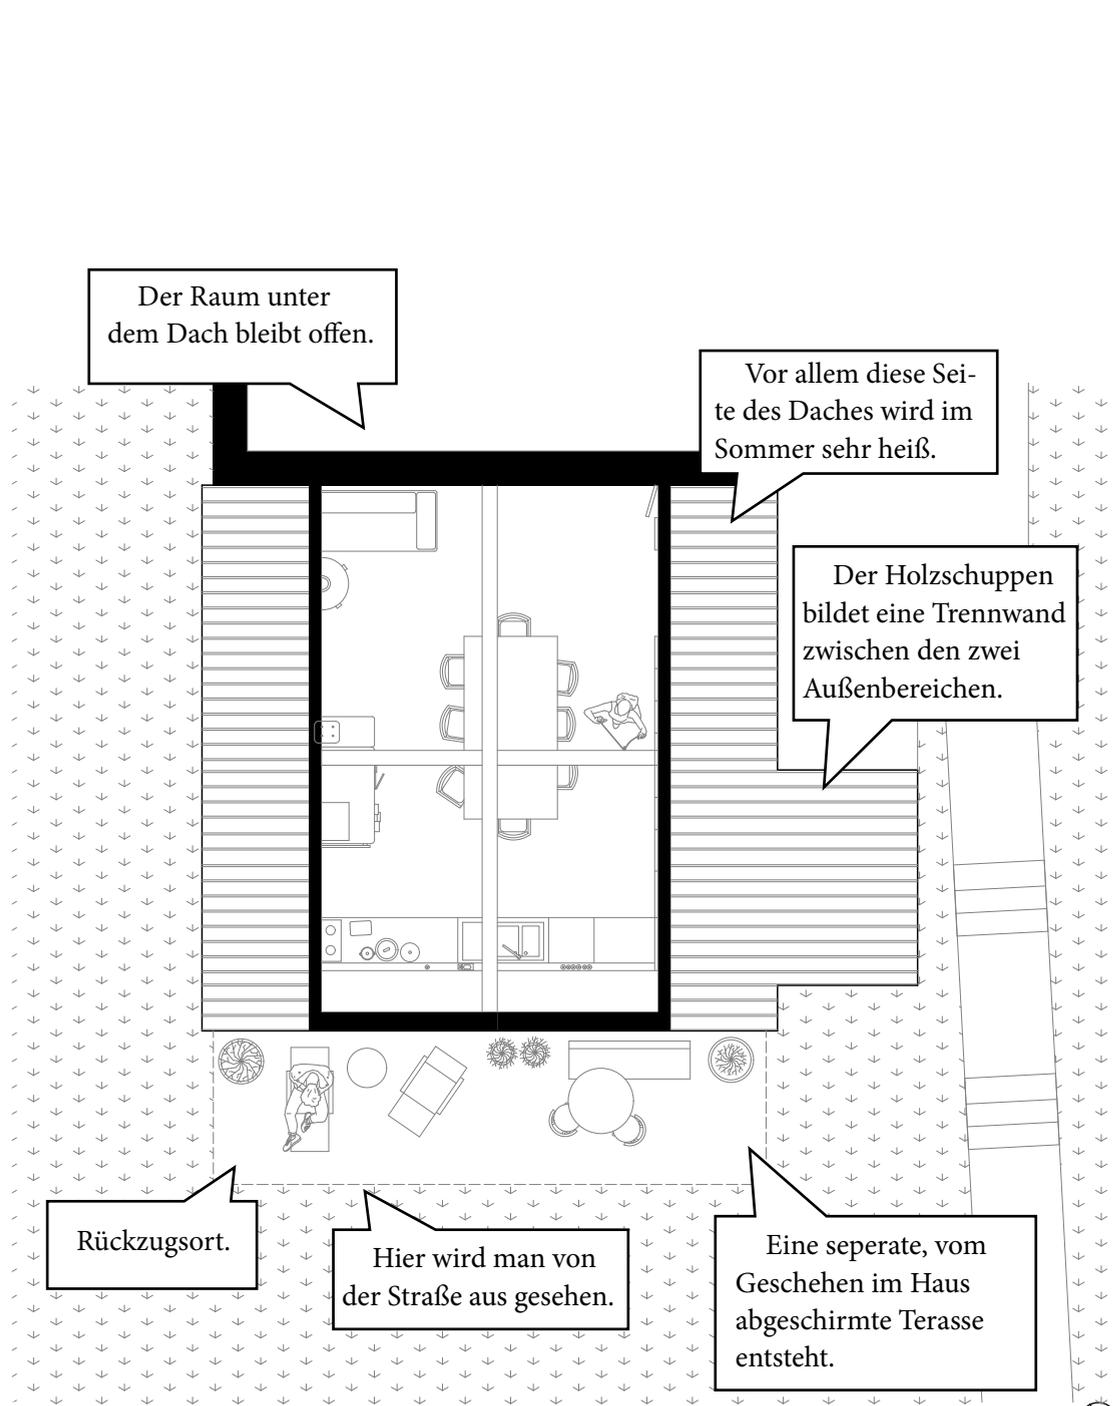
Grundriss Dachgeschoss 1:100
